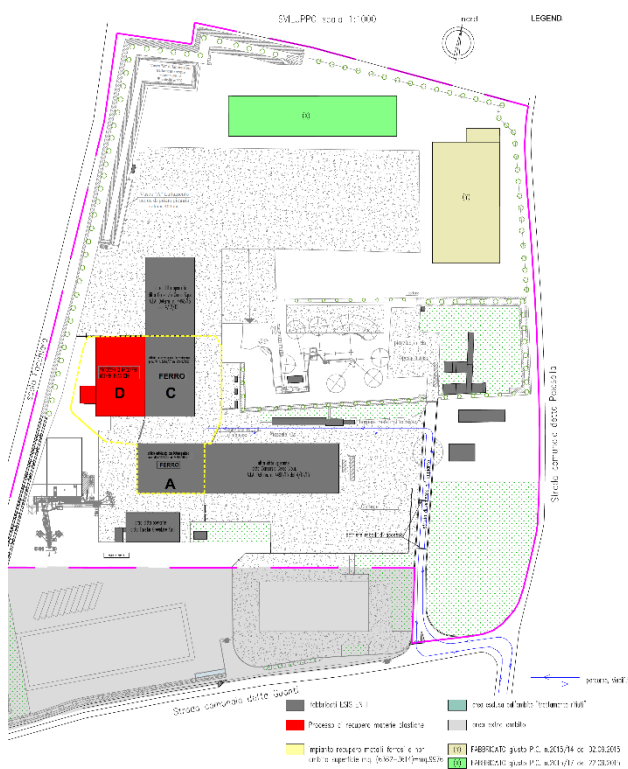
Planimetria dell'impianto con indicazione dei Capannoni A, C e D
